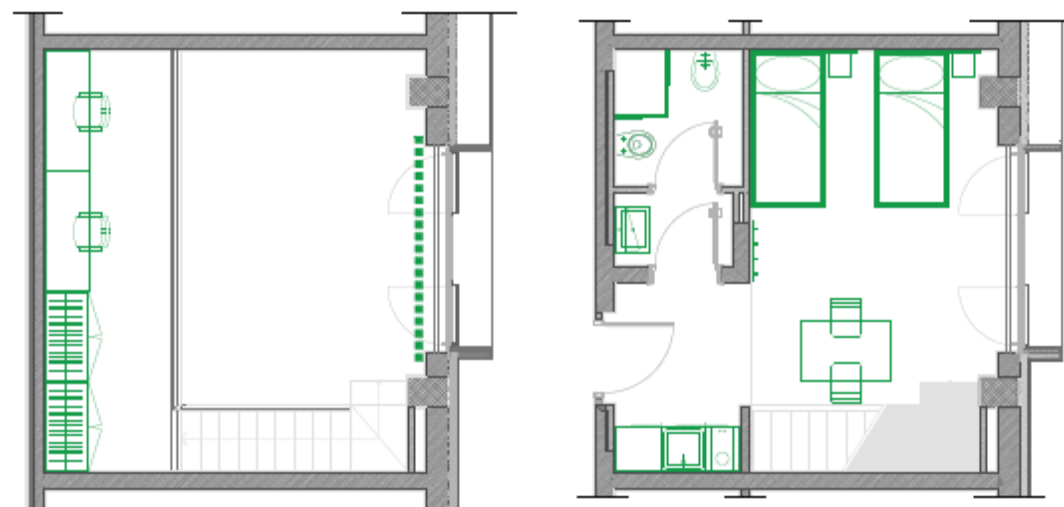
Pianta tipologia Mizar - Fonte: archivio In-Domus
